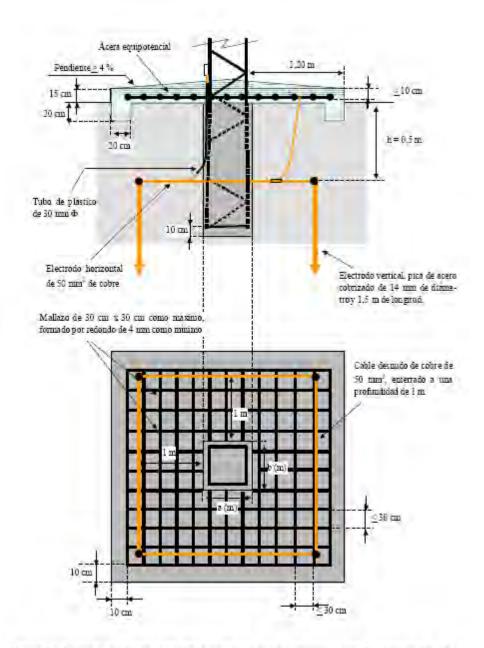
Acera de hormigón, con mallazo equipotencial, perimetral con la cimentación del apoyo, empleado en lineas aéreas con apoyos frecuentados con calzado.
